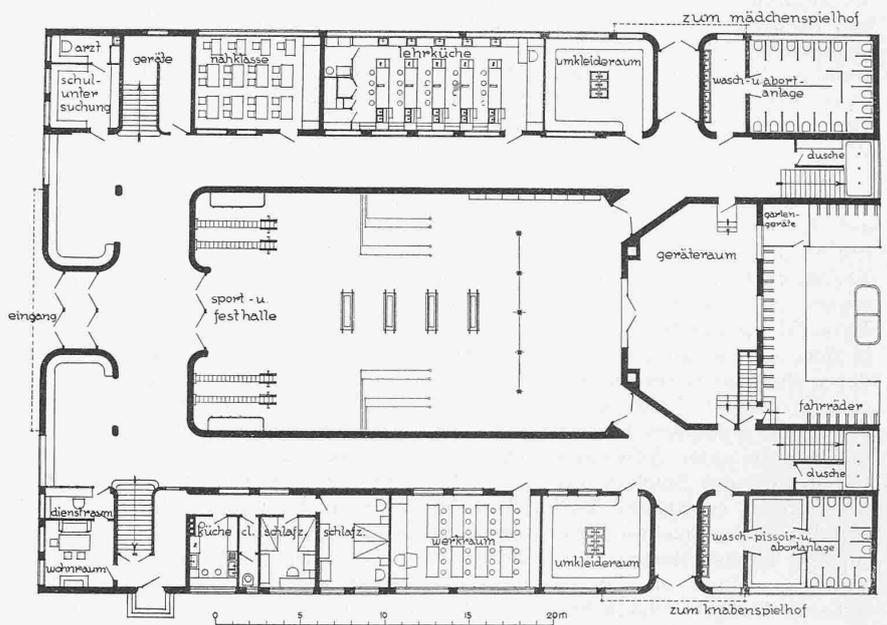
Erdgeschoss-Grundriss, 1:400. Orientierung: links Süd, rechts Nord.
